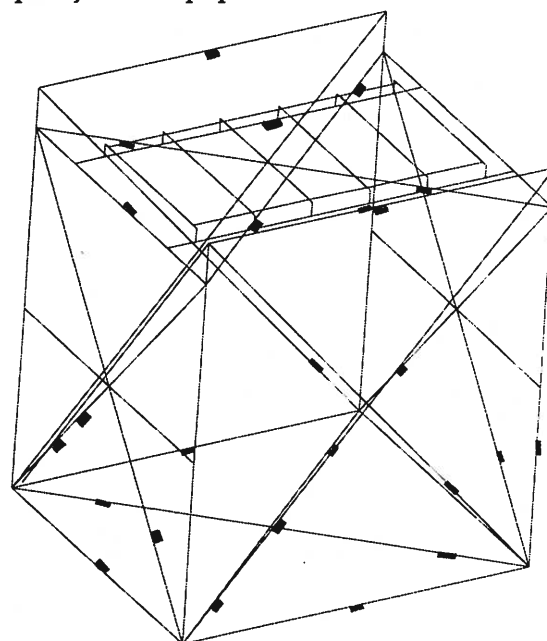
Esquema da disposição dos extensómetros no elemento modular instrumentado
